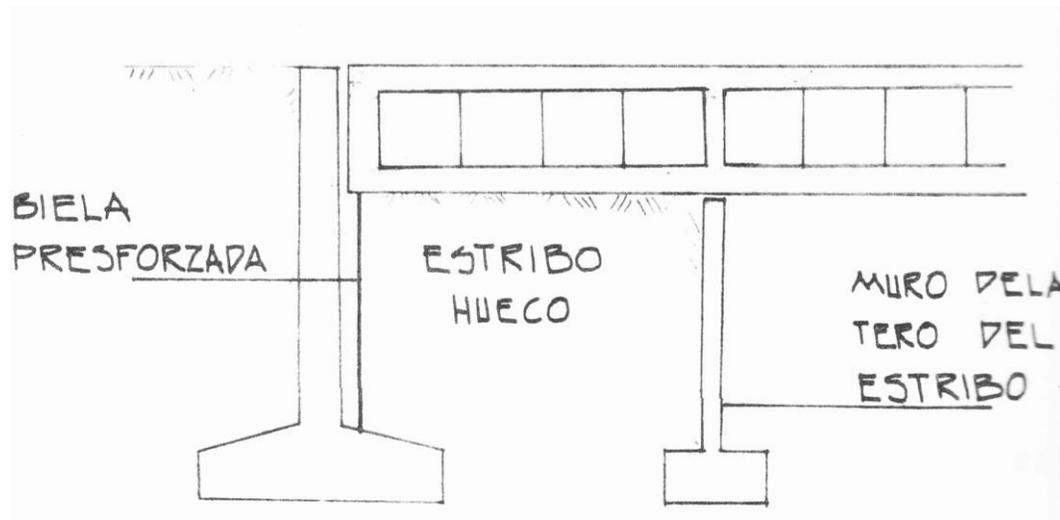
Esquema de voladizo apoyado sobre estribo para caso de luz extremidad grande
